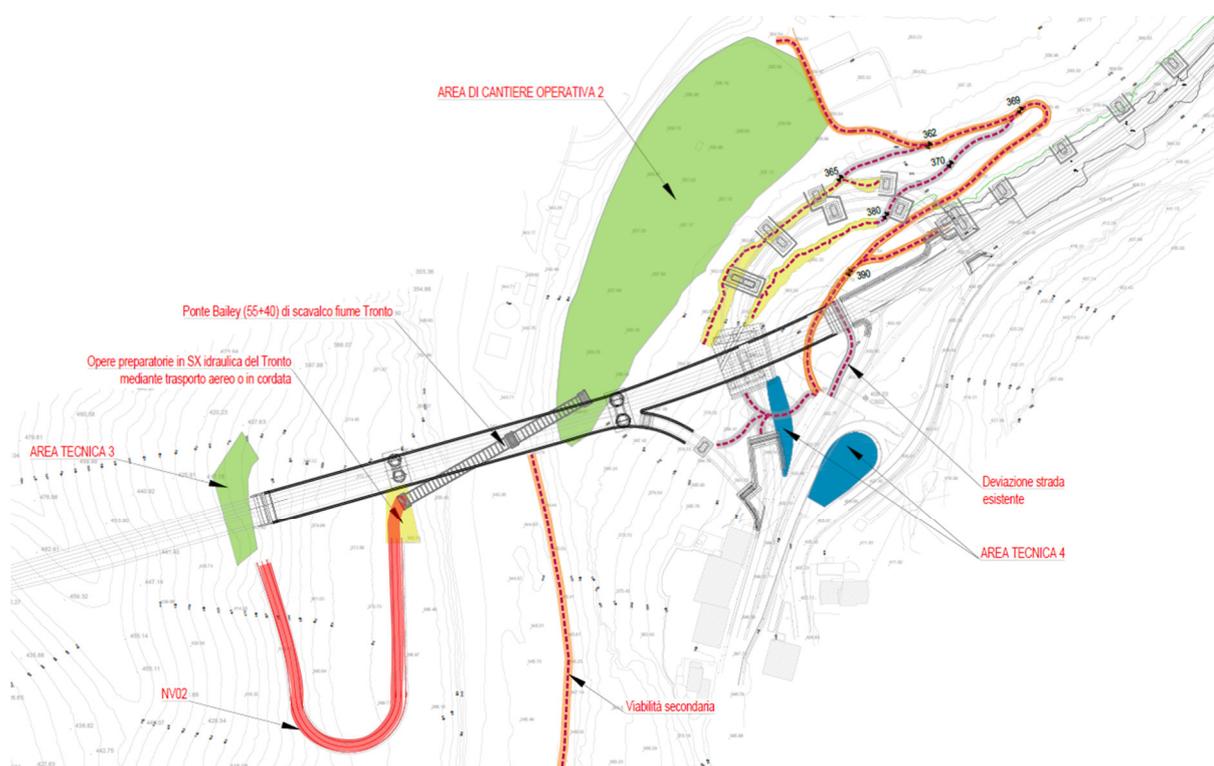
Dettaglio accessibilità in fase di cantiere – area svincolo
